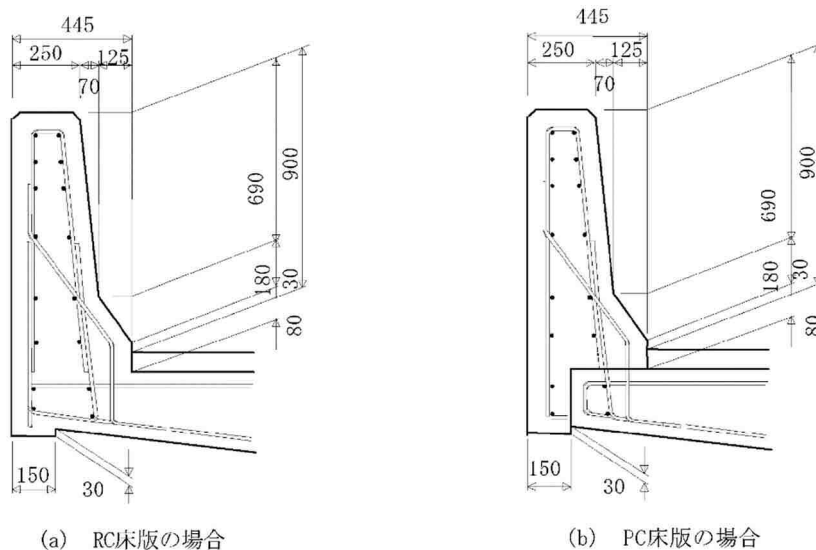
鉄筋コンクリート製壁型防護柵の配筋例（種別 SB）
